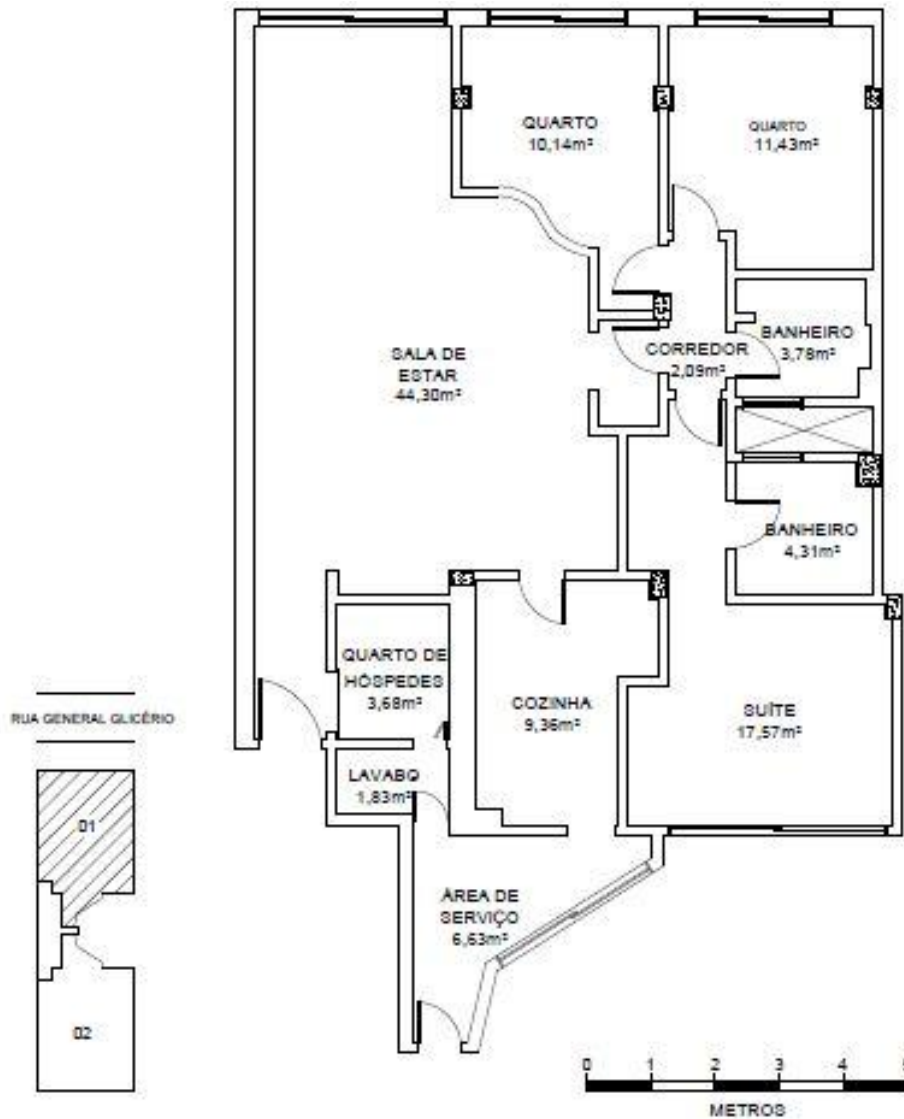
Edifício Paraíso – Planta baixa do apartamento
